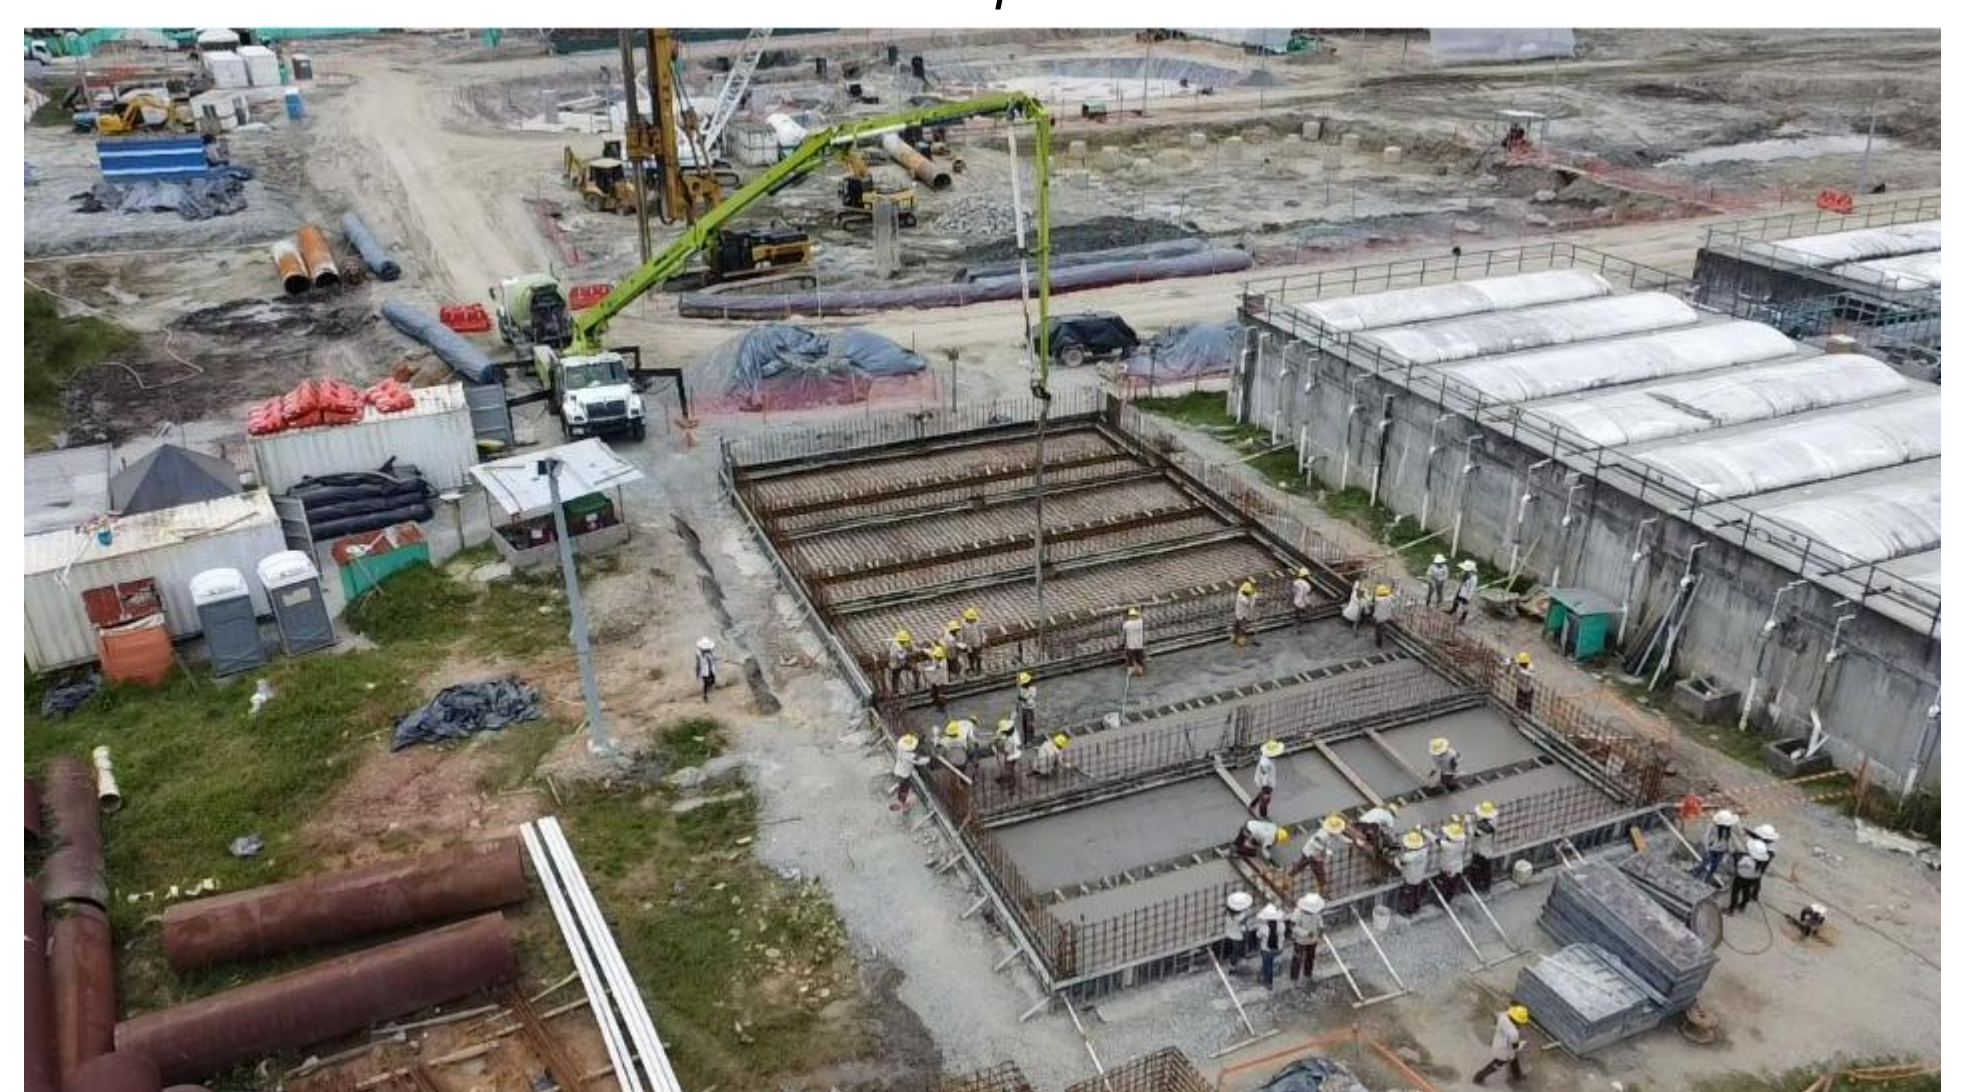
Fundición de losa de fondo de la estructura de lechos de secado.
